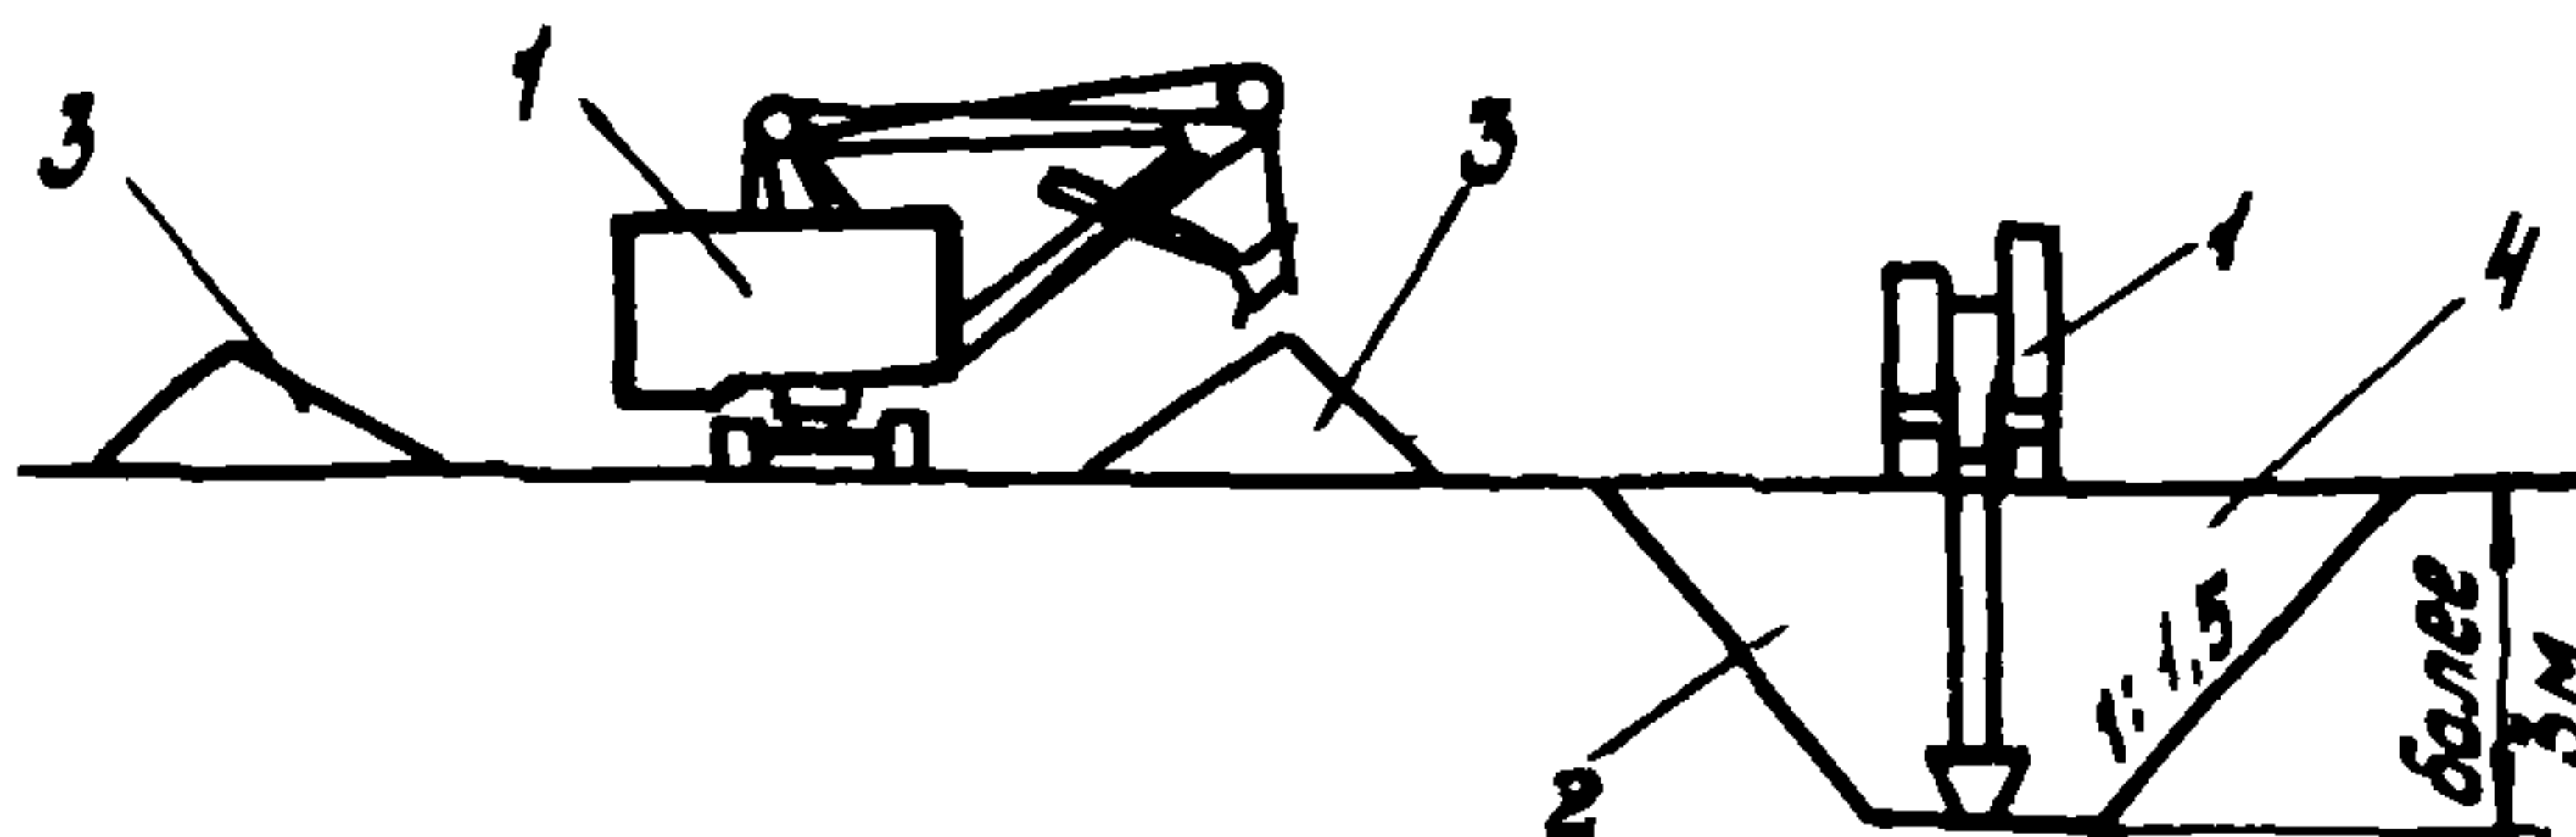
Разработка глубоких траншей в слабых грунтах с двойной перекидкой грунта:
